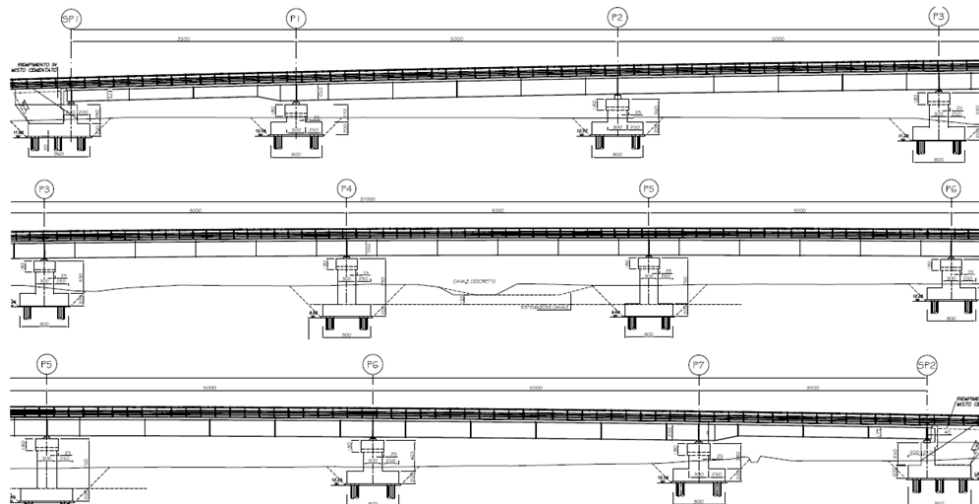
Viadotto Ozzoretto: profilo longitudinale
